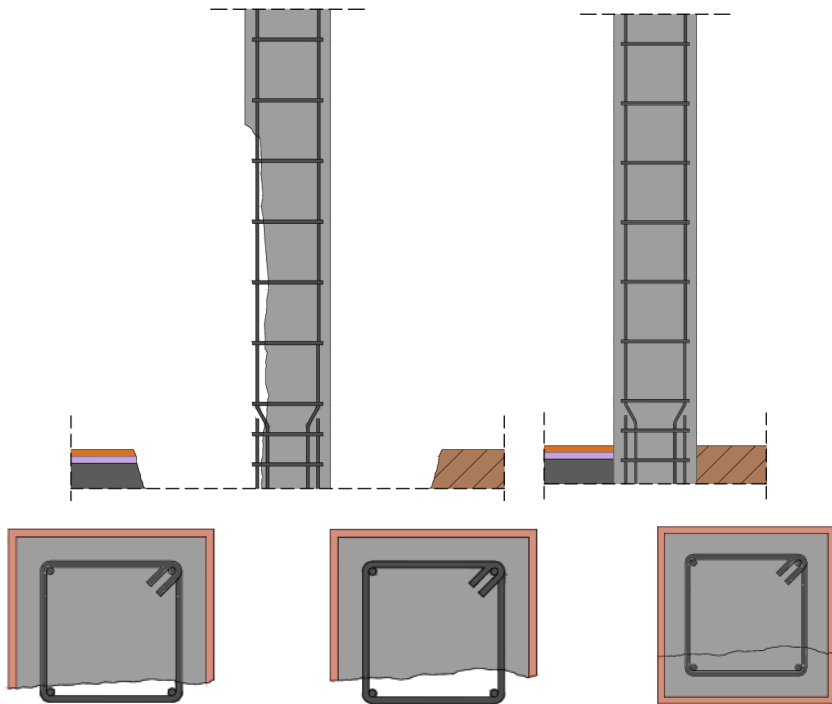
Detalle pilar antes y después de reparación. 2024. Fuente: Propia
